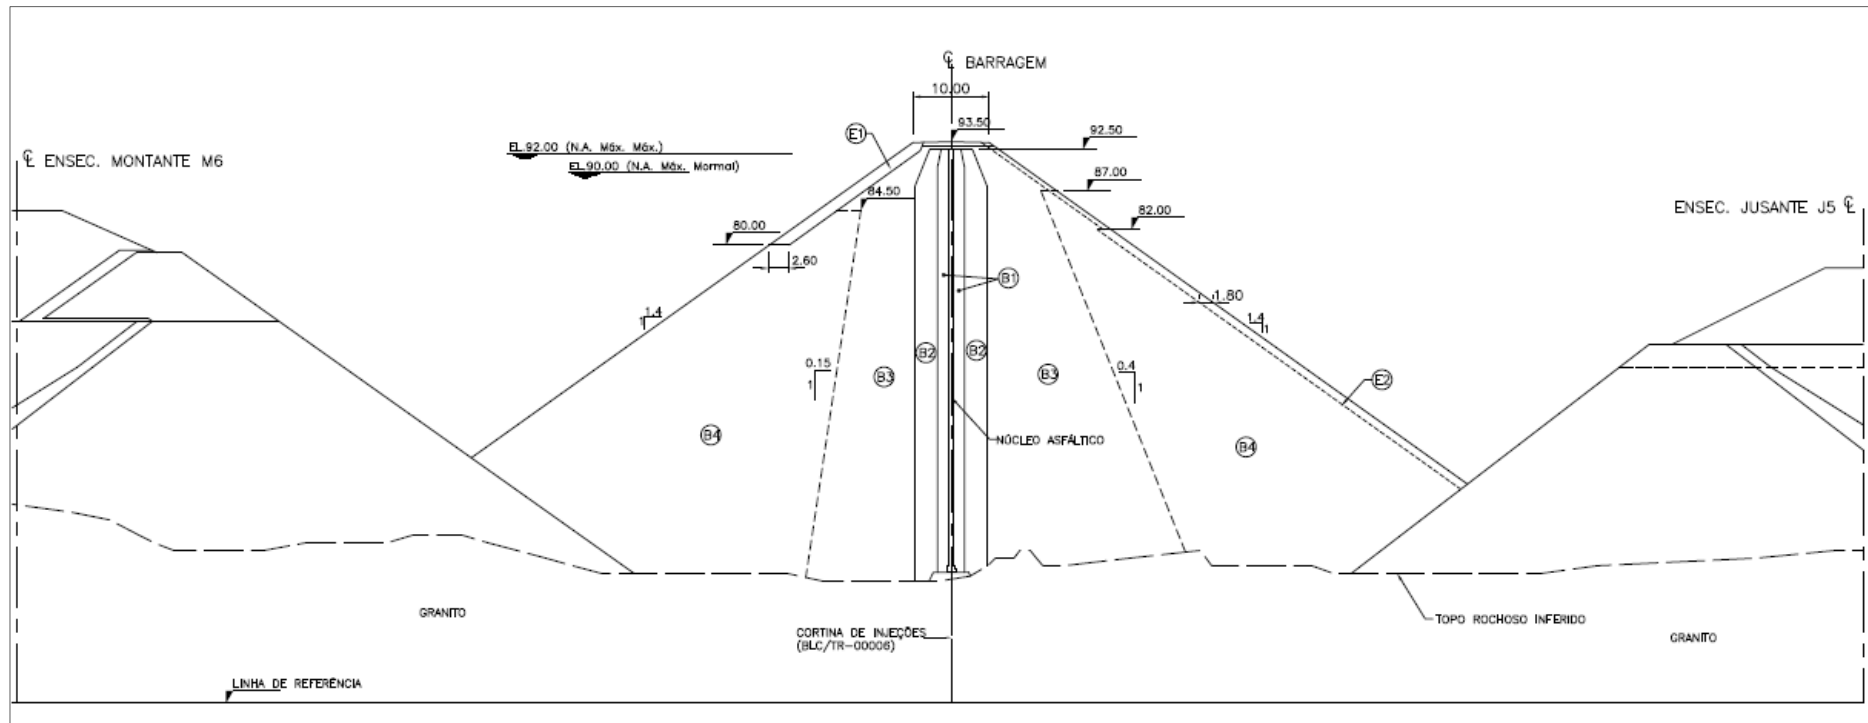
Planta baixa da barragem principal e ensecadeiras (RAMALHO et al., 2013)
